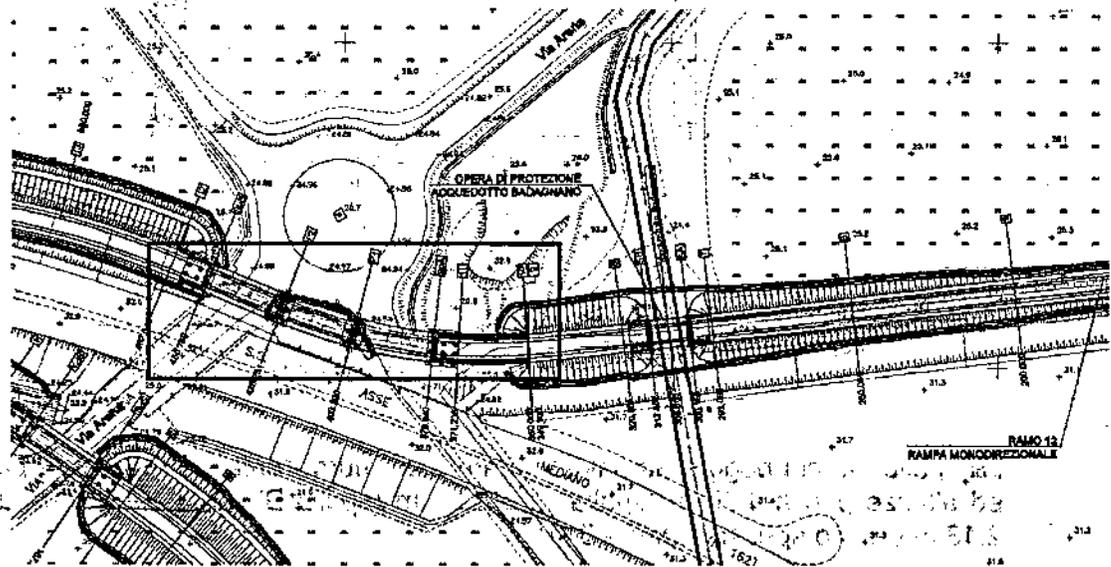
Stralcio planimetrico "ramo 12" (asse appoggio sulle spalle) e presenta tre campate di lunghezze pari a 24.50 m/23.05 m/24.24 m (asse appoggi) misurate in asse tracciamento.
